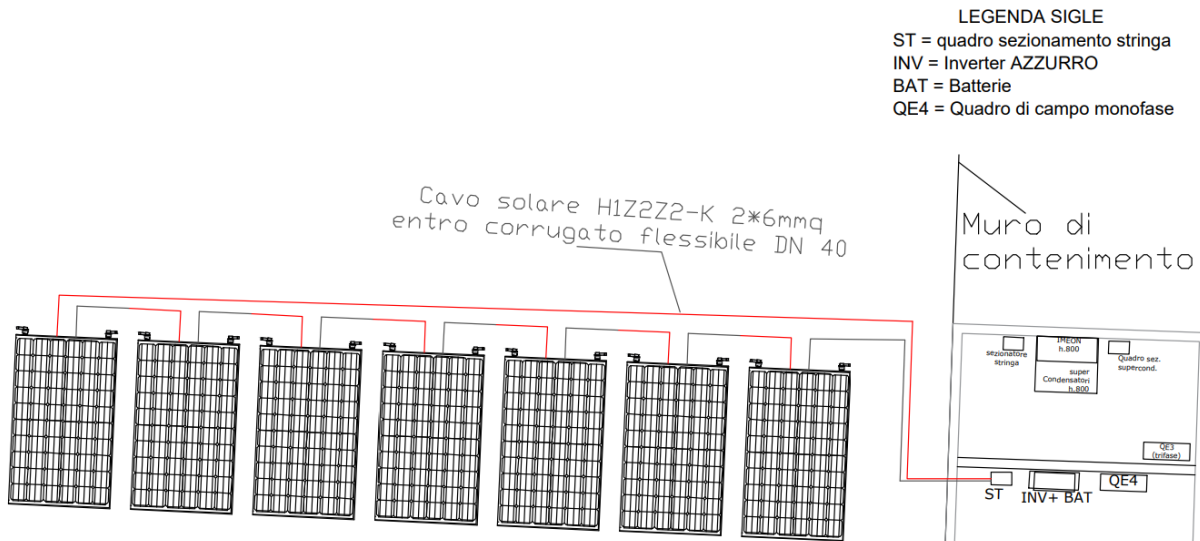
schema connessione elettrica moduli PVT ai componenti installati in cabina
